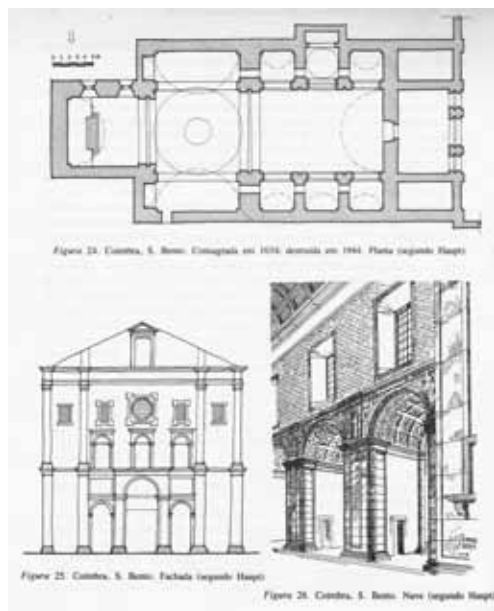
Coimbra, S. Bento. Planta (segundo Haupt)
